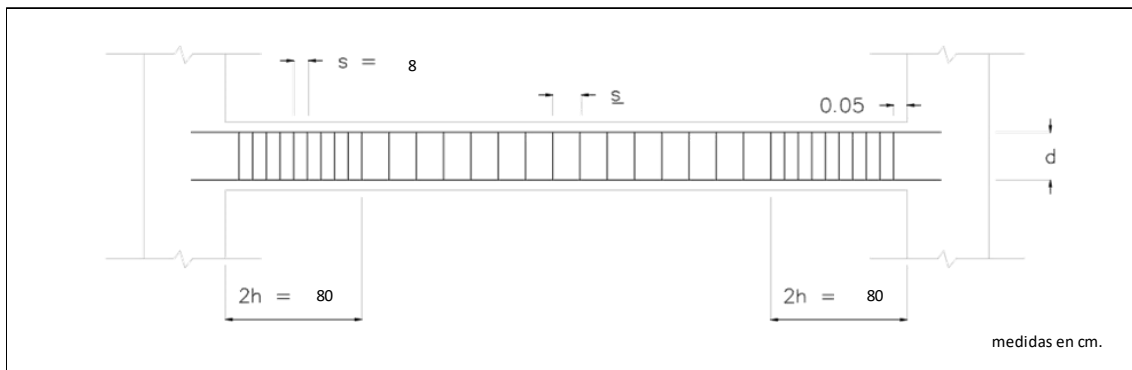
Distribución de Acero de Refuerzo por Corte
